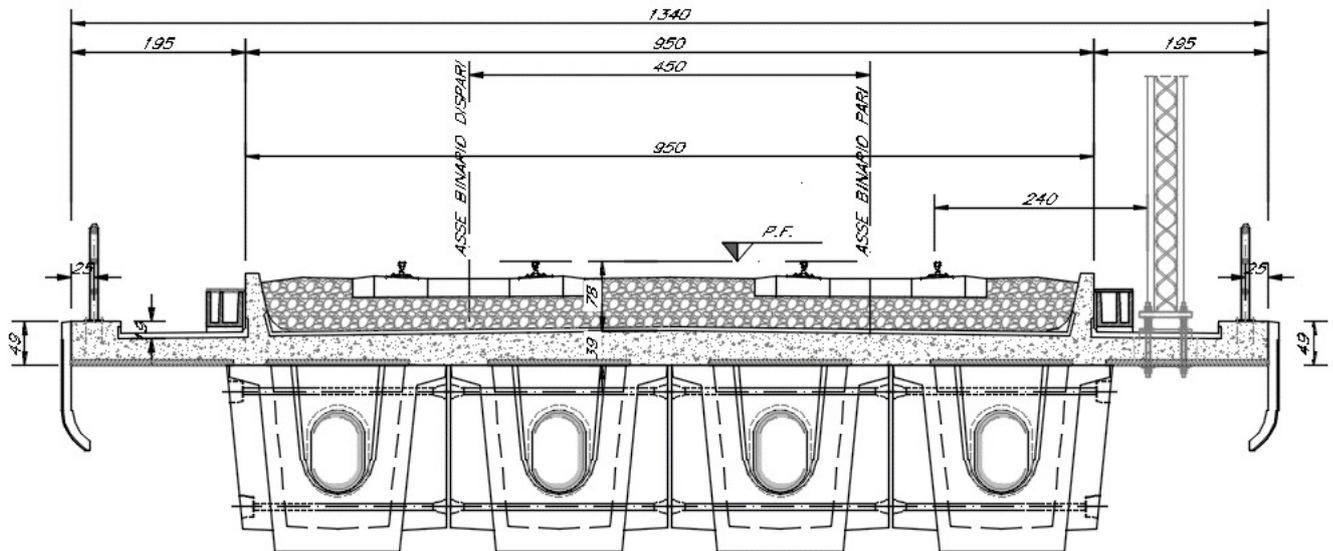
Sezione trasversale dell'impalcato in c.a.p.
